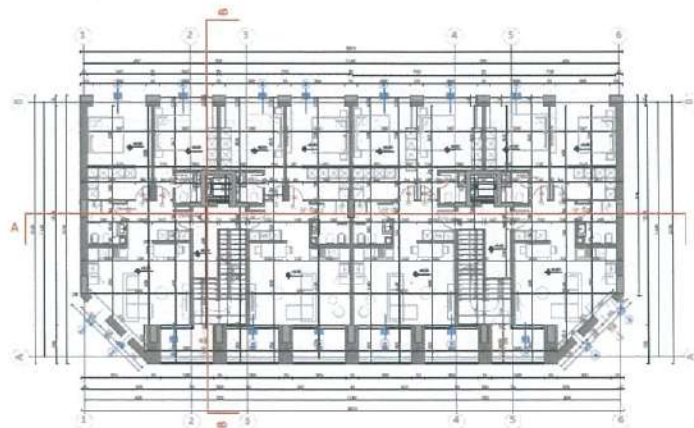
Planimetria e katit përdhe, Objekti 6, Prona Veriore
